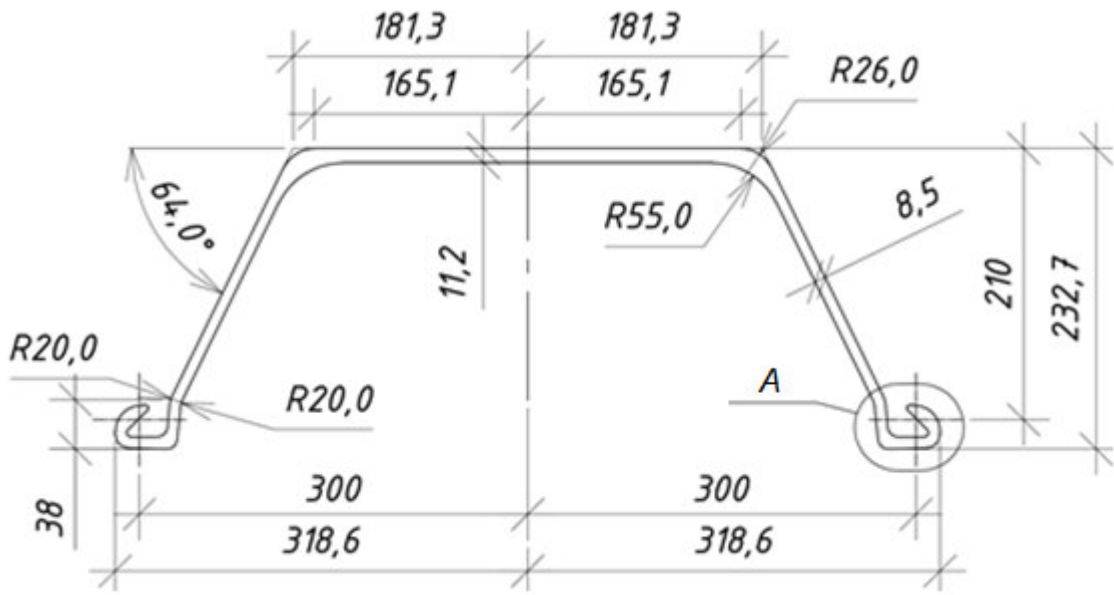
Конструкция шпунта Л6-16НТ
